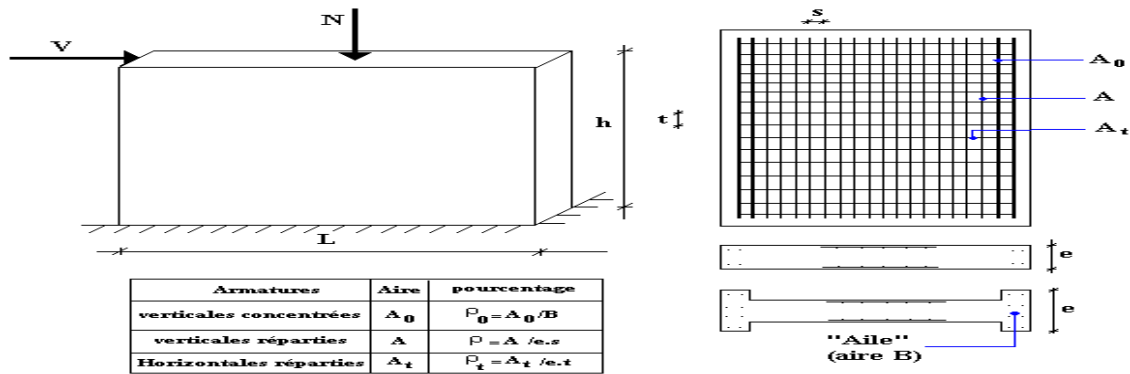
Schéma d'un voile et disposition du ferrailage.
